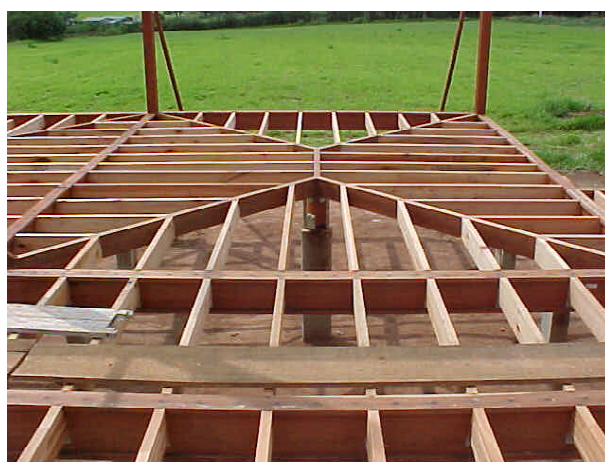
Viga de Madeira Laminada Colada e sua utilização como barrote de piso.
